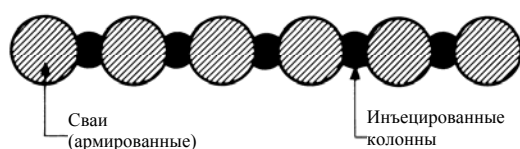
Схема комбинированной стены для коробчатого фундамента: армированные буронабивные (или шнековые сваи) и инъецированные колонны
